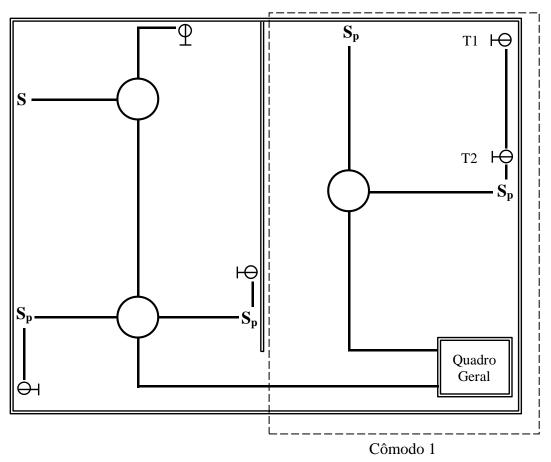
Planta baixa simplificada para projeto de instalação elétrica
